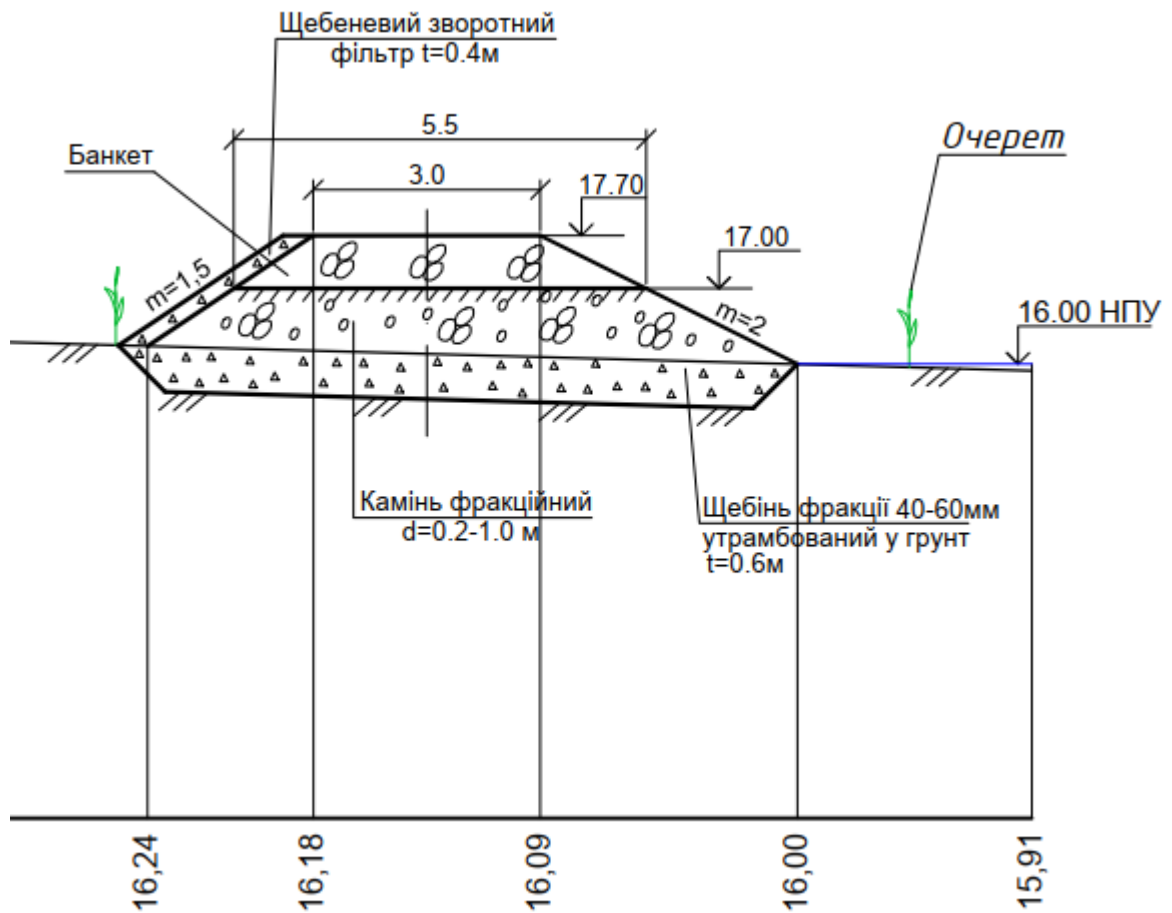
Поперечний переріз кам'яного насипу берегоукріплення
